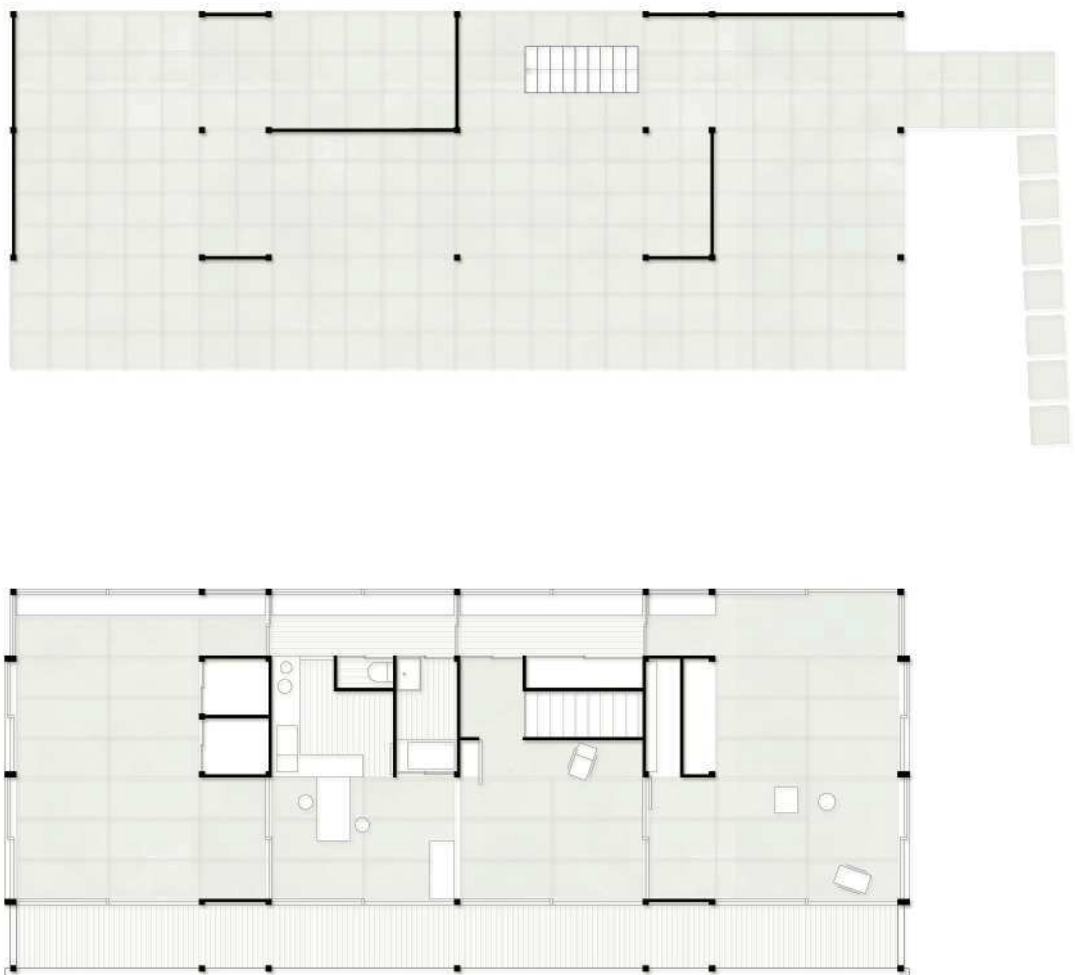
Figura de autor. Planta baja y primera residencia Tange.
